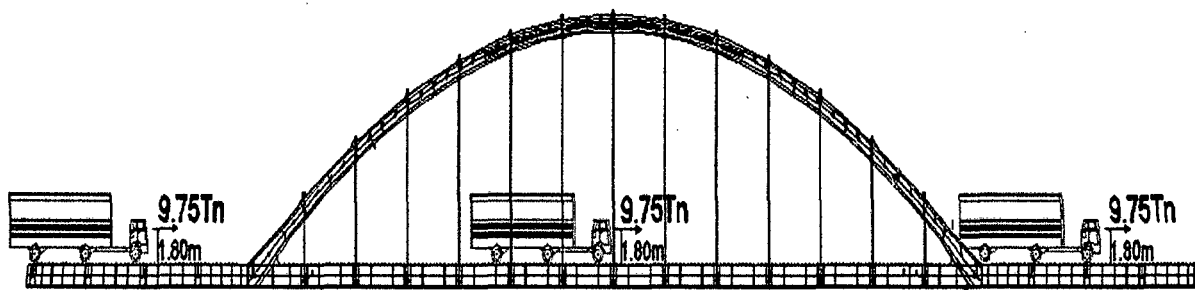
Acción de la Fuerza de Frenado – Camión de Diseño HL-93.
